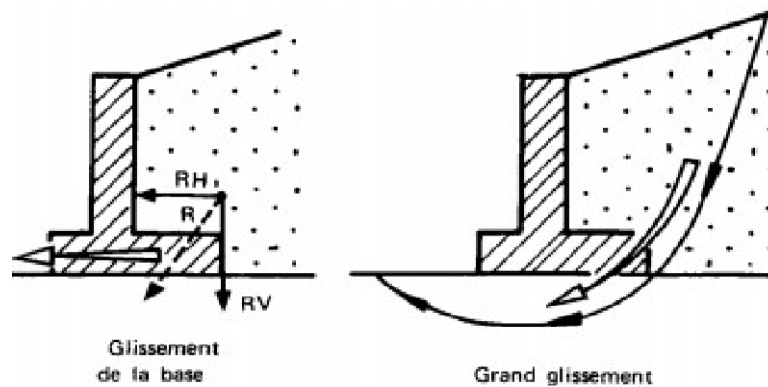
stabilité au glissement d'un mur de soutènement [16].
